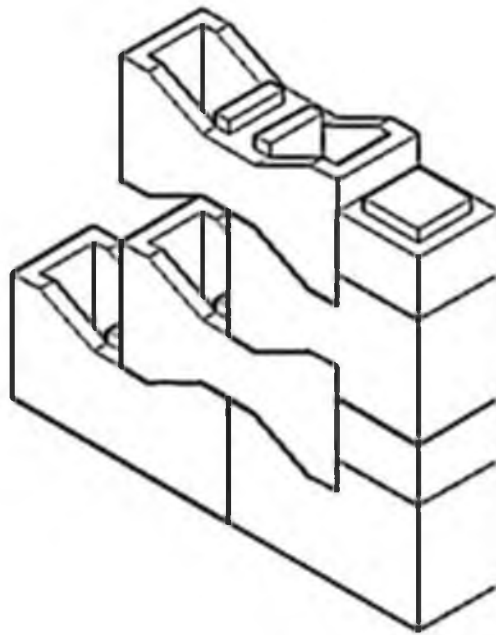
Uso de las piezas base, cierre y calce, en la construcción de un muro unilateral.
